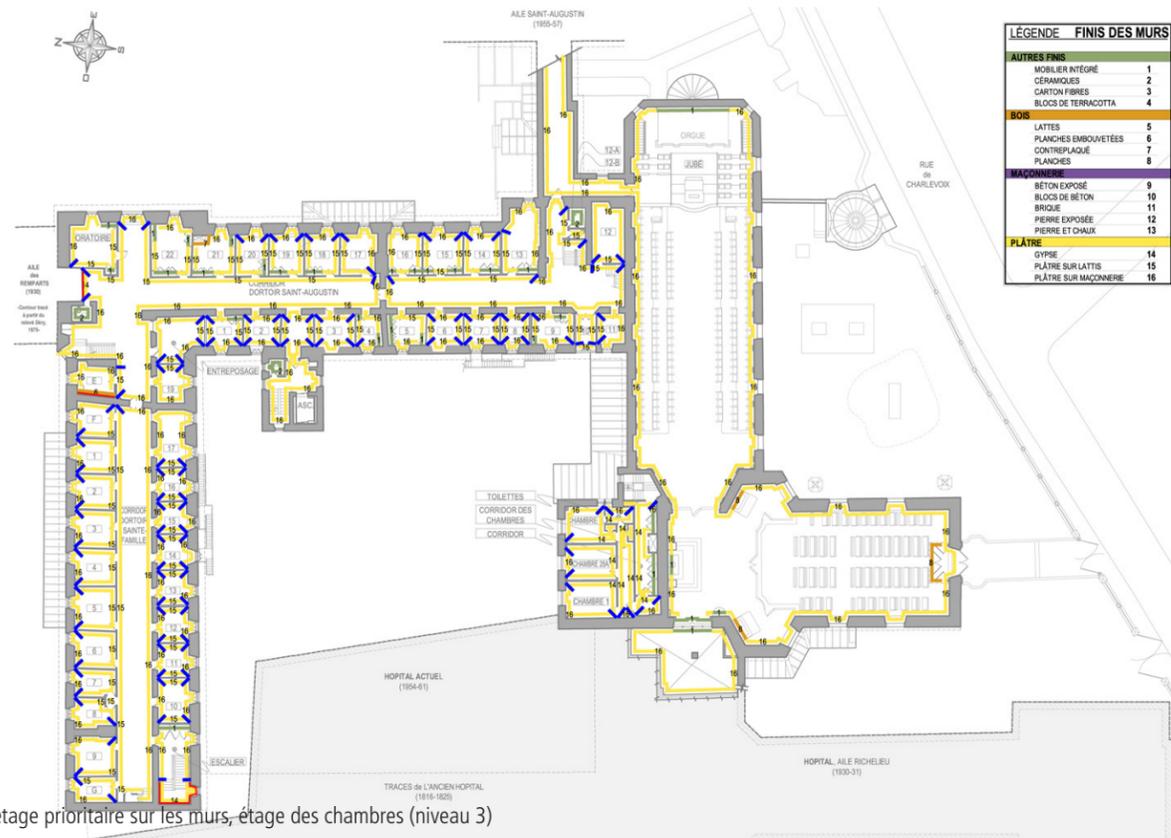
Plan de curetage prioritaire sur les murs, étage des chambres (niveau 3)
